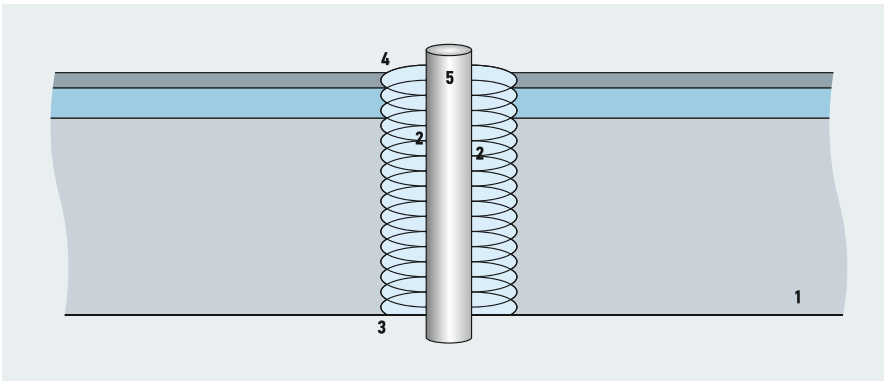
Провод полипропиленовых трубопроводов через перекрытия (1 — перекрытие; 2 — минеральная изоляция требуемой степени огнестойкости; 3 — штукатурка; 4 — силиконовая замазка; 5 — стояк)
